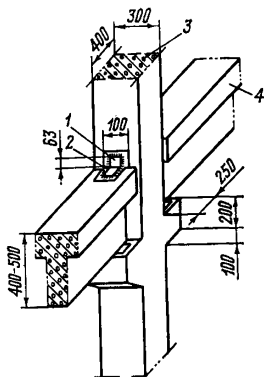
Узел опирания прогона на колонну в сборном несущем каркасе
